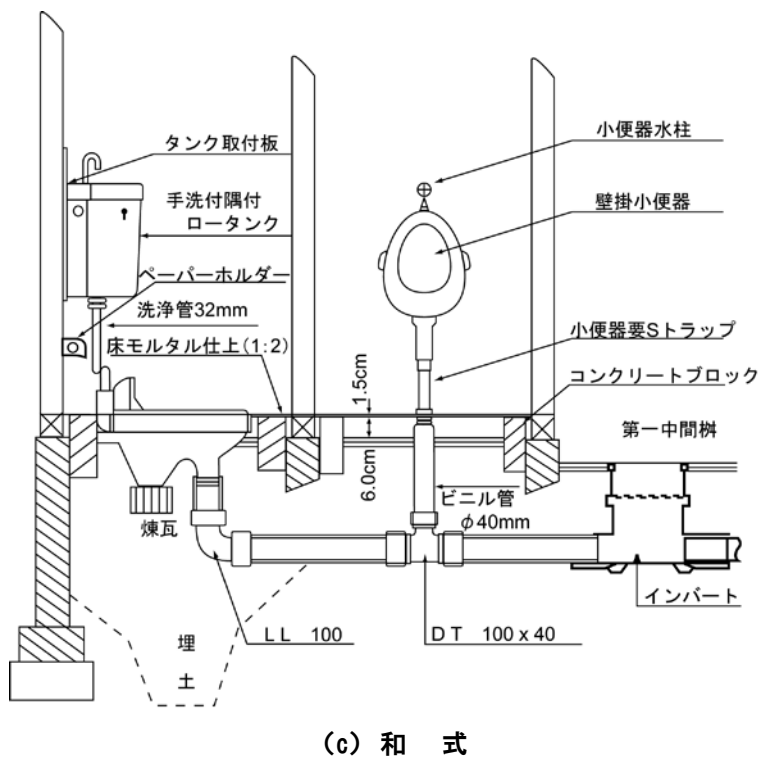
1 1 くみ取り便所の改造の施工図 (2)
